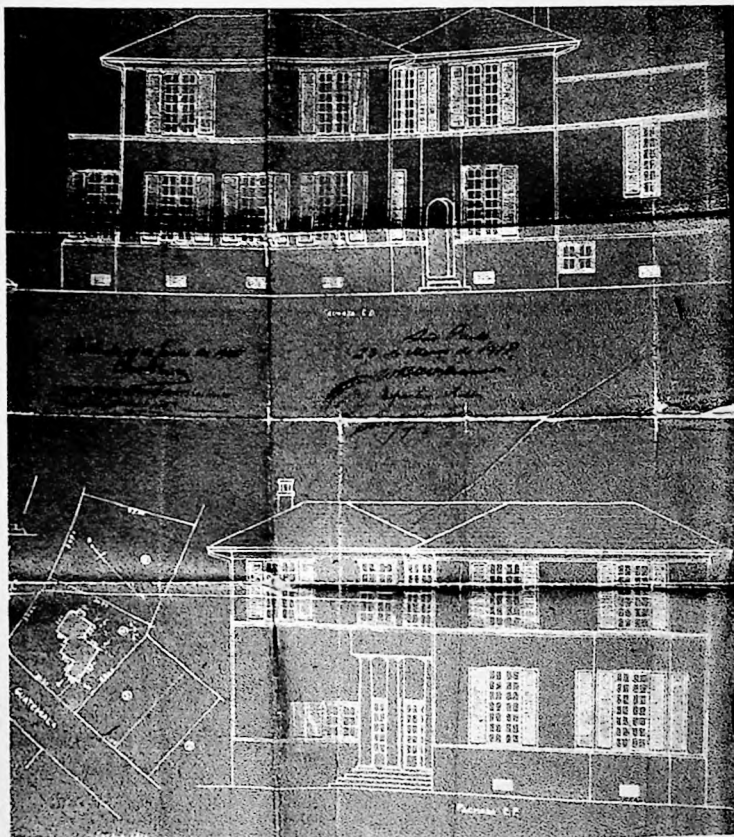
| Casa Miller, plantas e fachada (Arquivo da Cia. City)
